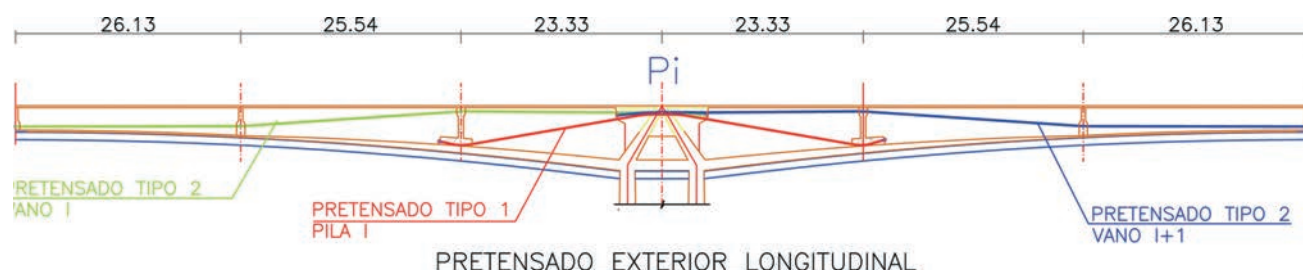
Pretensado exterior longitudinal. Alzado, familias tipo 1 y 2.
